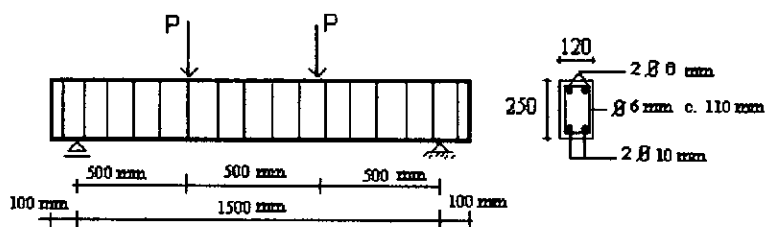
18 – Características das vigas ensaiadas por GEMERT et al.
